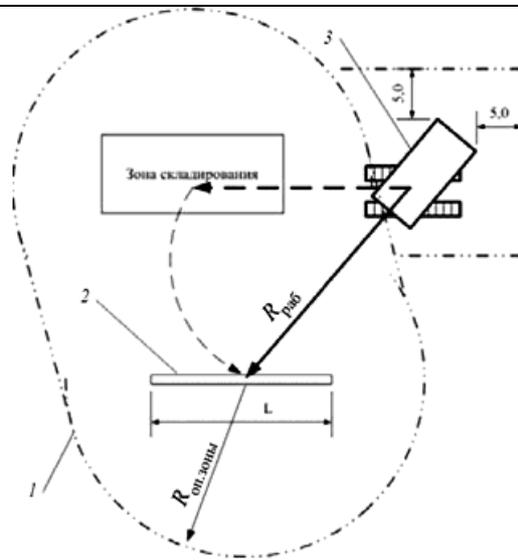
Расчетная схема определения опасной зоны при перемещении груза краном:
